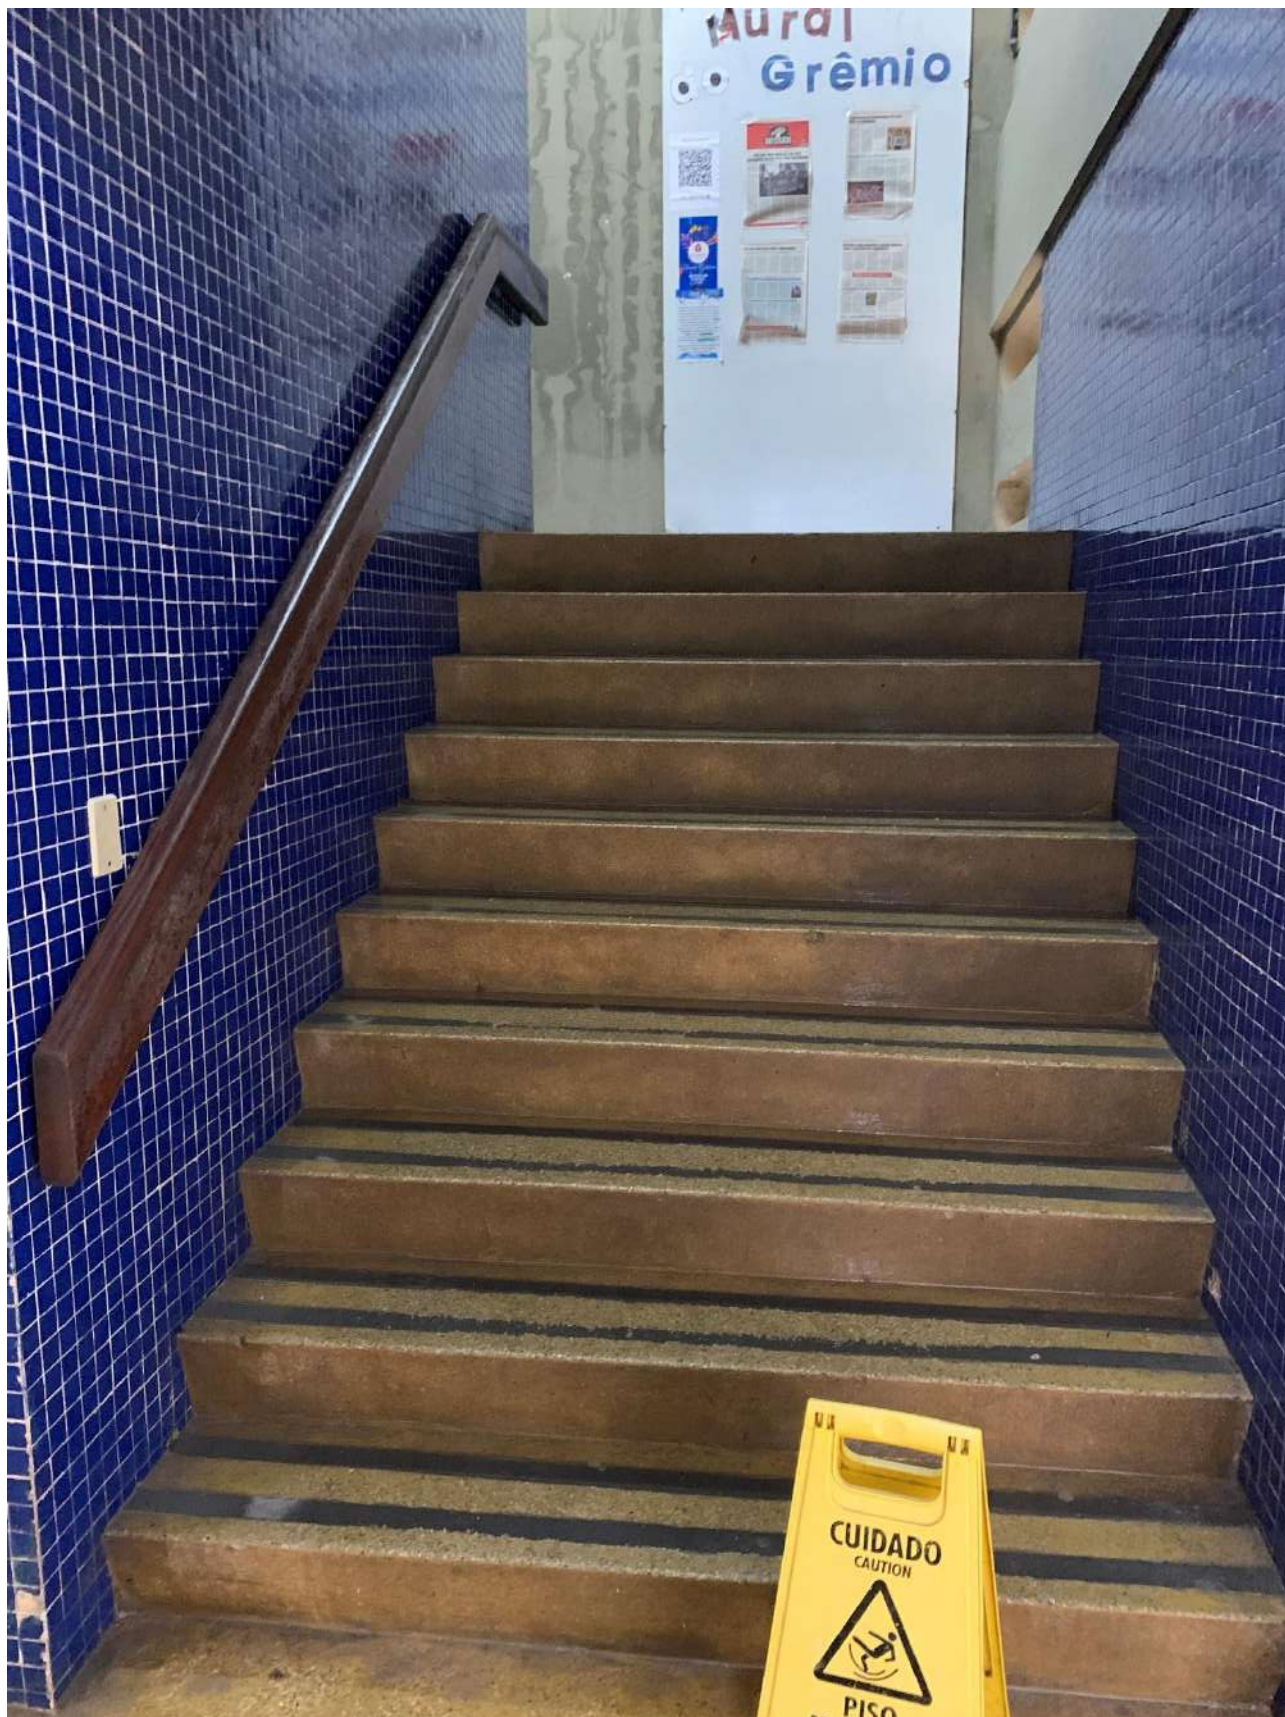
Infiltração na escadaria de acesso ao 2º pavimento CAp
